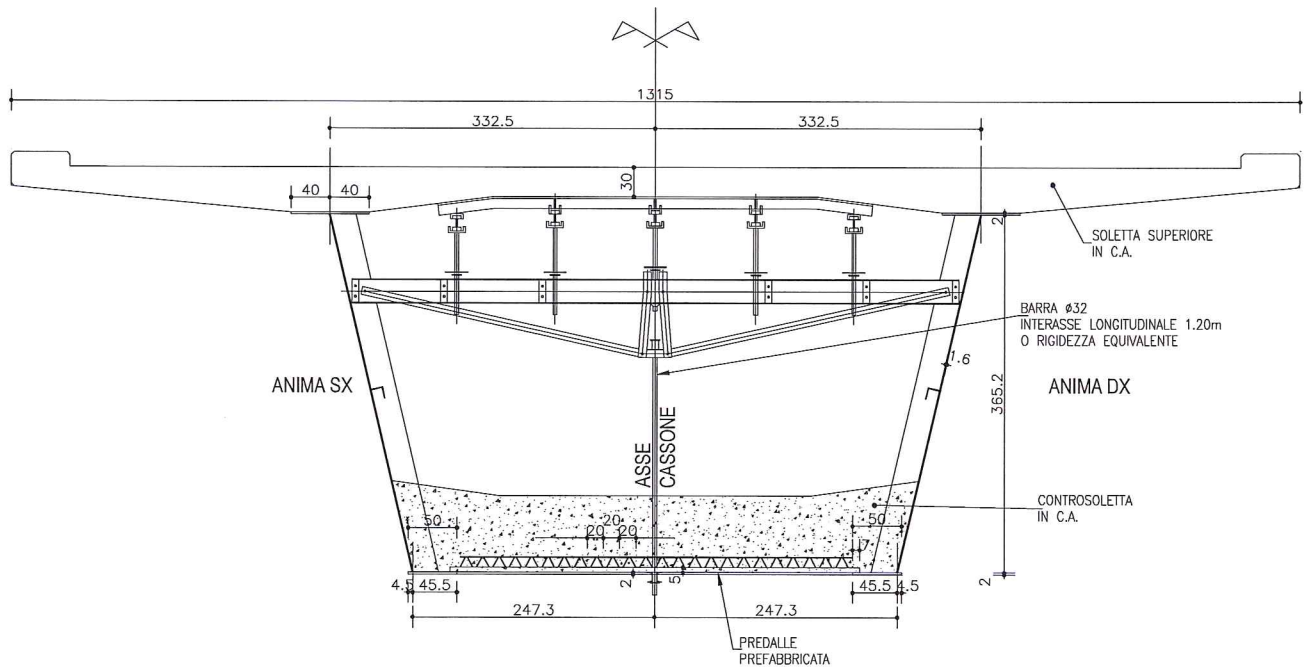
Posa delle prédalles per realizzare la soletta inferiore.
